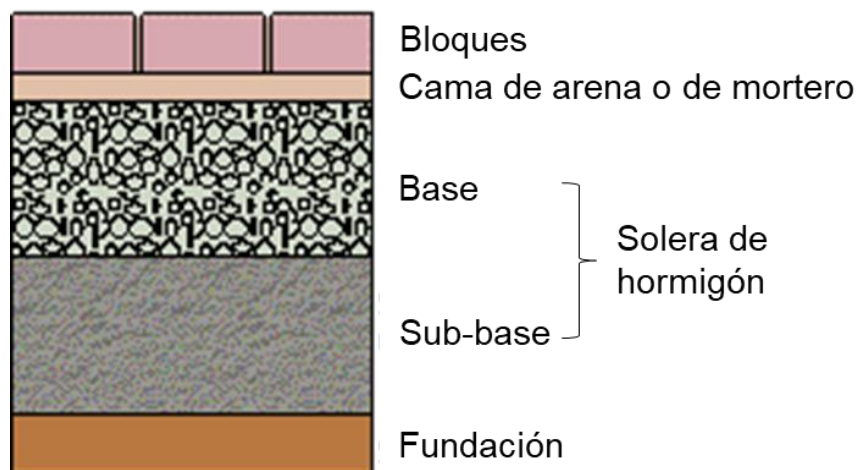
Esquema de sección de pavimentos por bloques. Adaptado de (McCormack, 2006)
